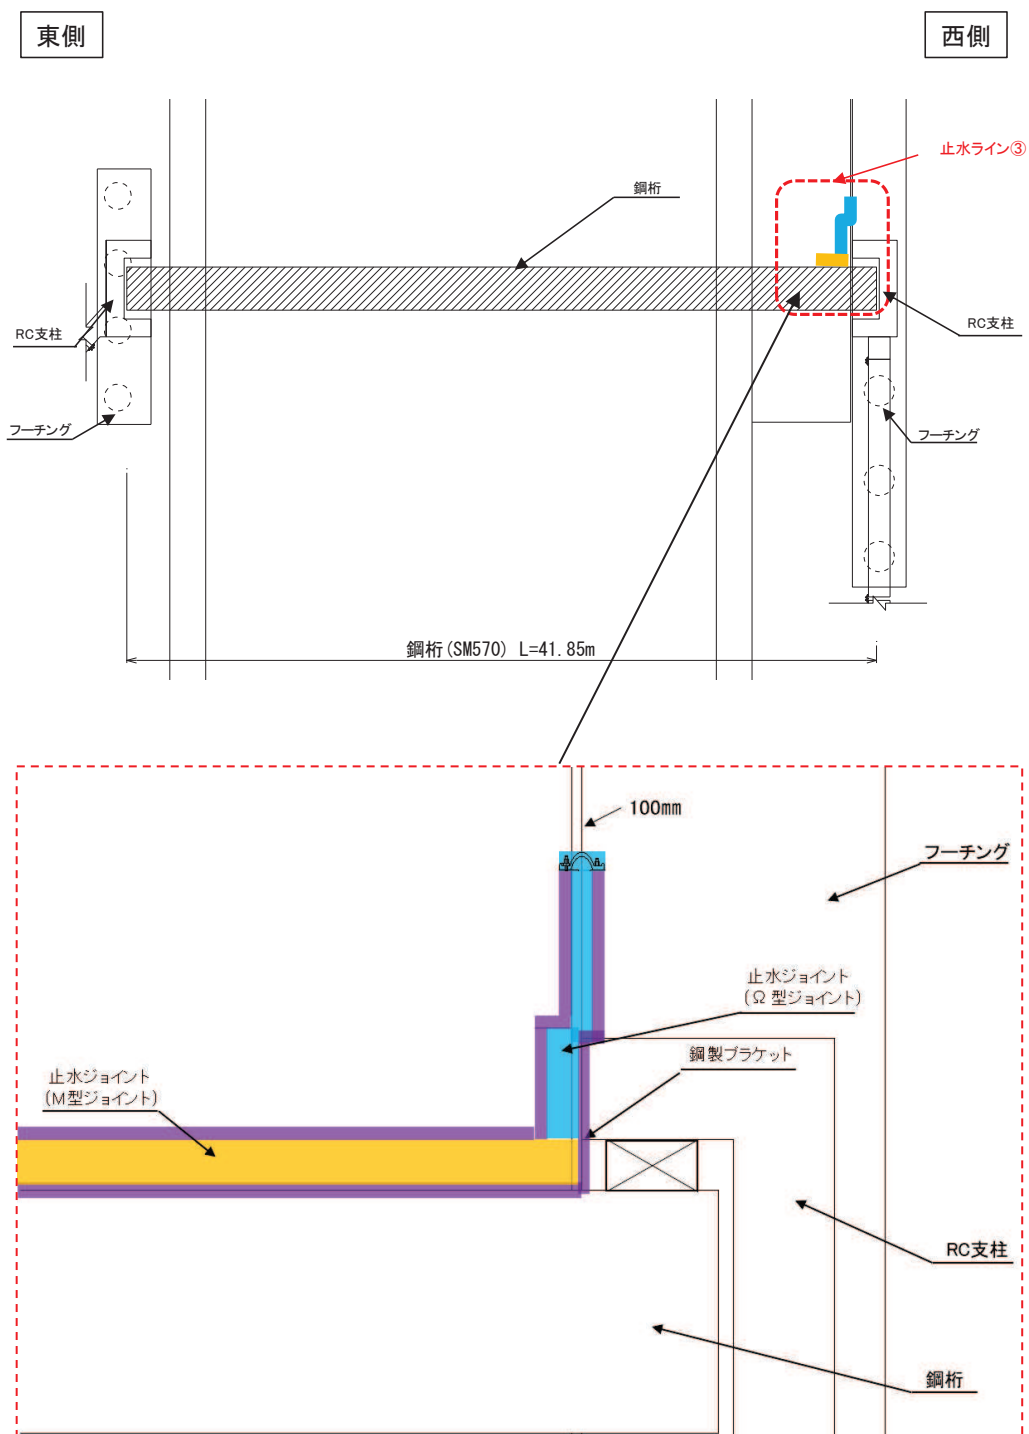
(2) 止水ライン③の構造概要(平面図)
